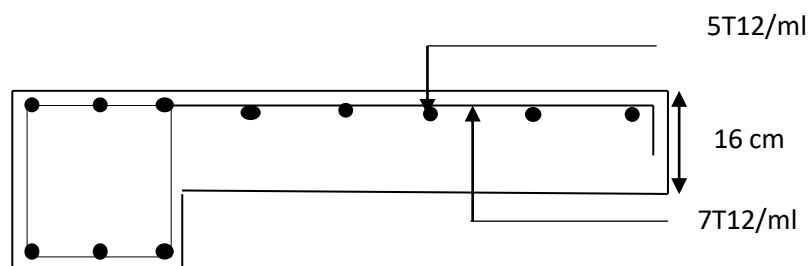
Schéma de ferrailage du balcon (Type 1,2)
